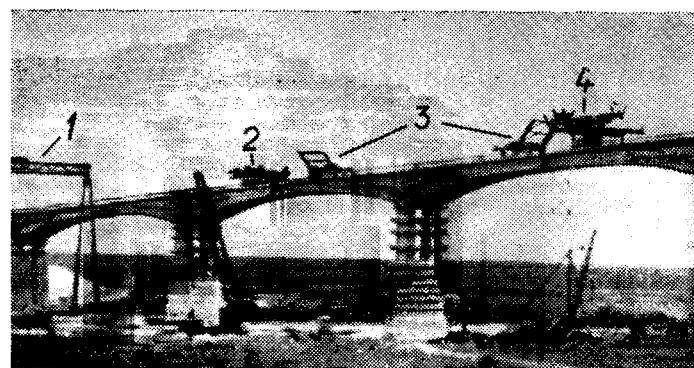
Краны, применяемые для монтажа пролетных строений:
